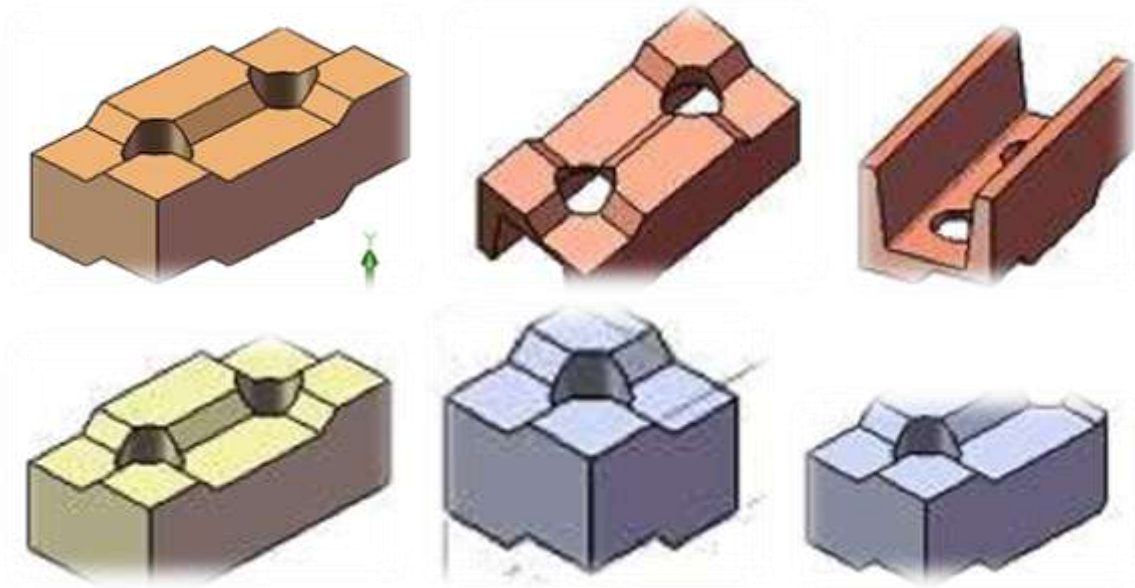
Sistema constructivo para muros: Bamba (Simion, 2009)
